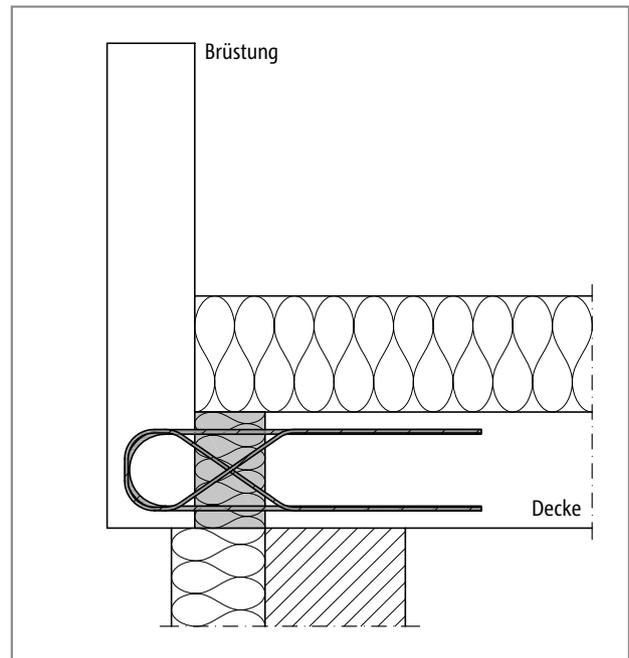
Schöck Isokorb® Typ ABXT horizontale Anordnung: Anschluss einer Brüstung
